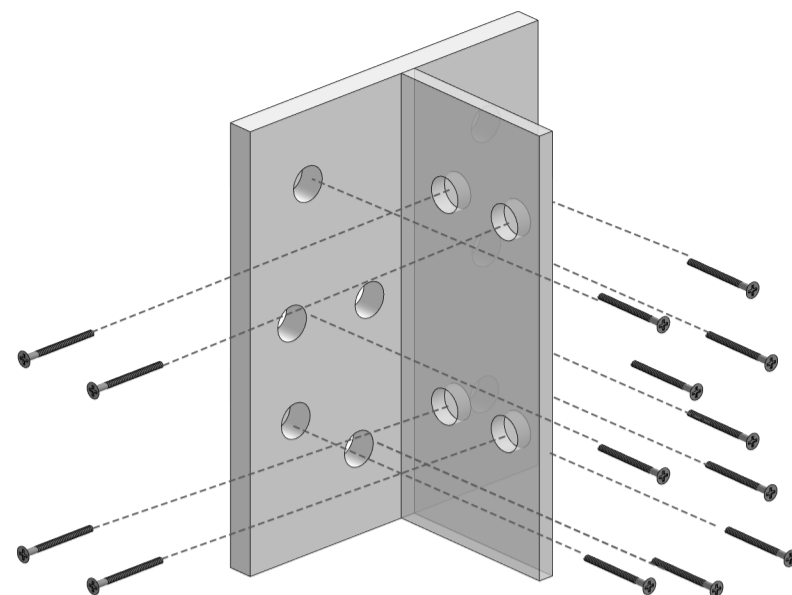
Detalhe peça de travamento/ligação da estrutura da cobertura. Fonte: Autora.
